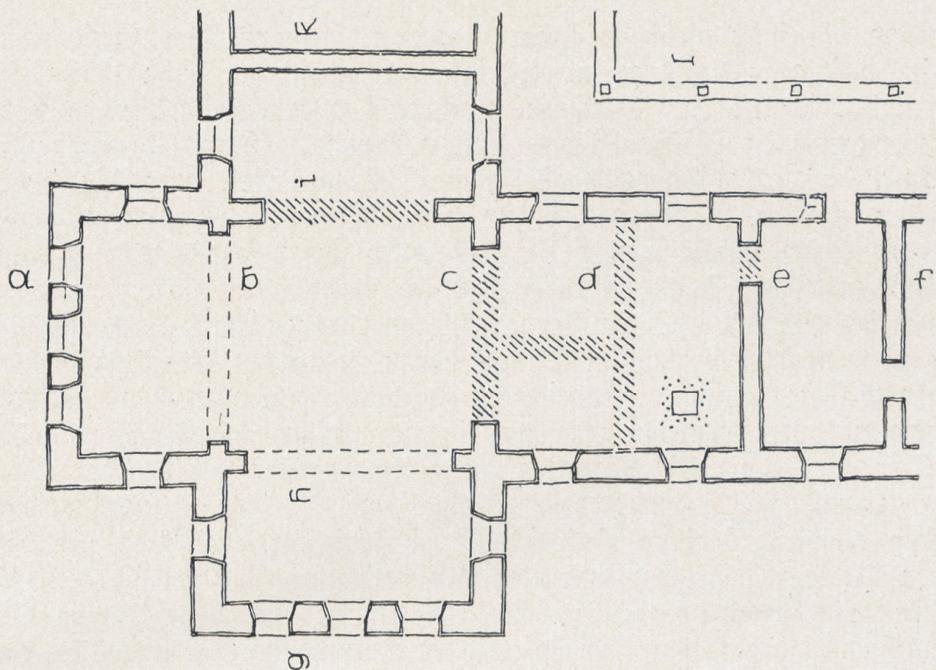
Erste Kirchenperiode, Grundriss 1:300.
